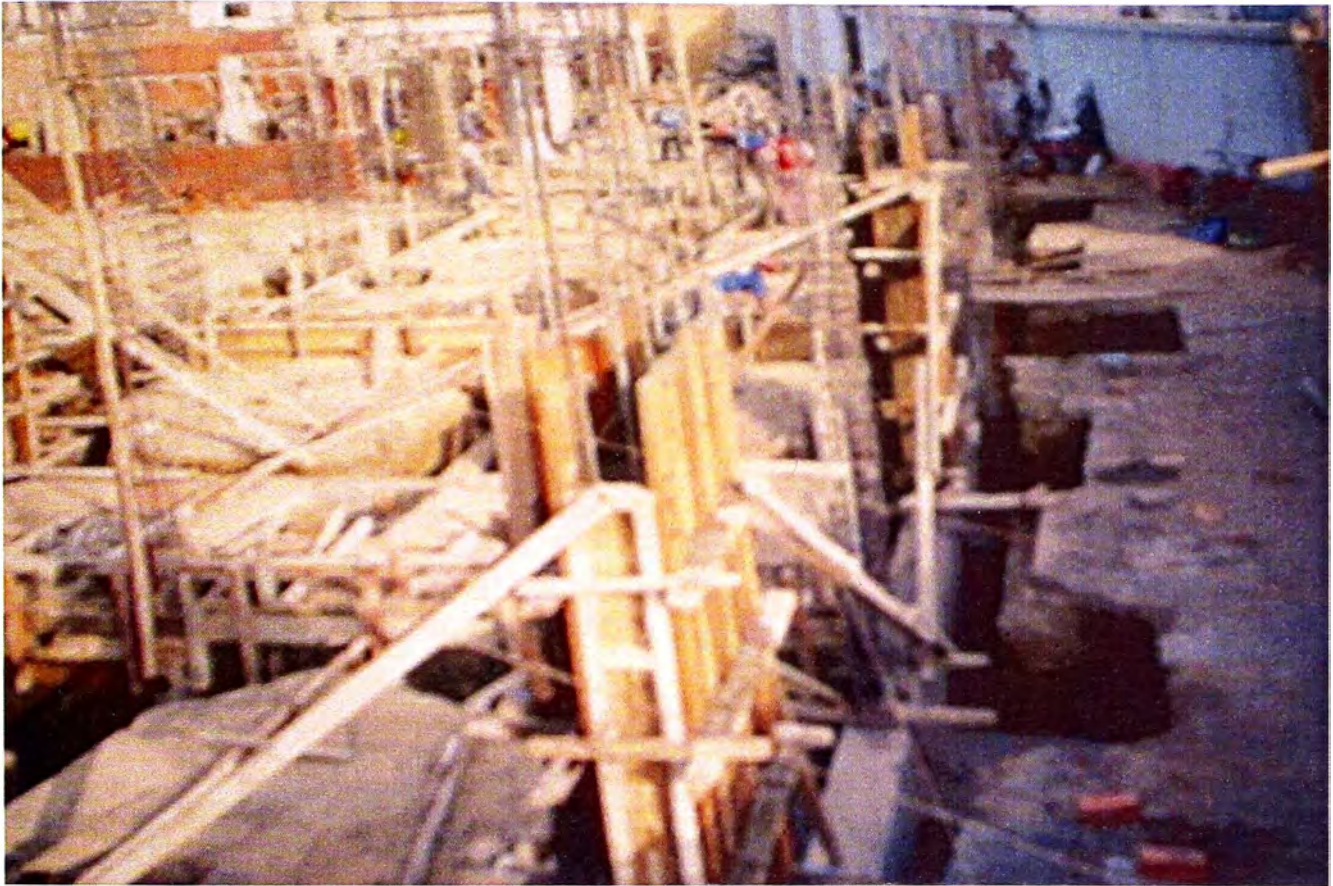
VISTA DE ENCOFRADO DE PLACAS Y SOBRECIMIENTOS Y DEMAS
